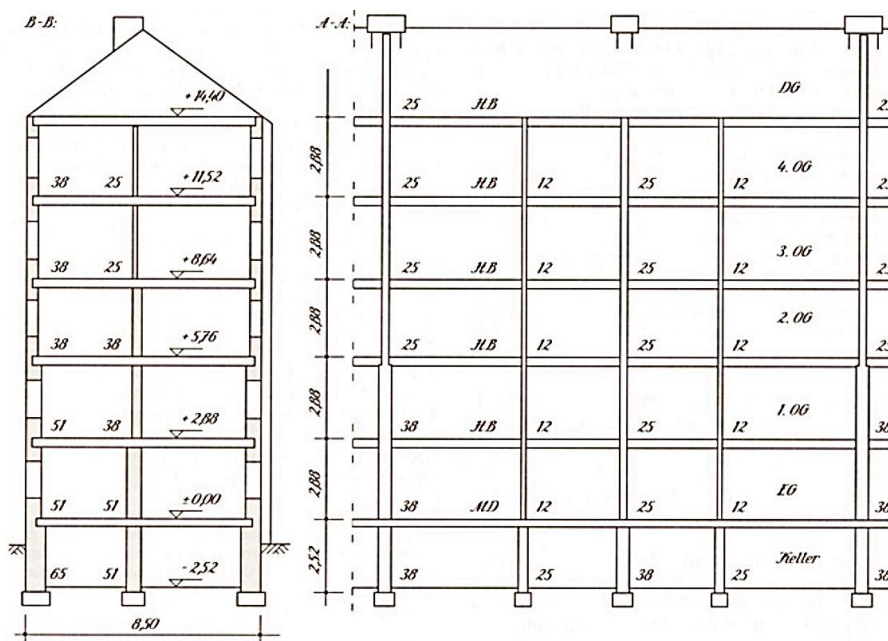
Wohnhaus Bautyp Altbau 1950 deckentragende Längswände mit 38-65 cm Außenwanddicken [98]
